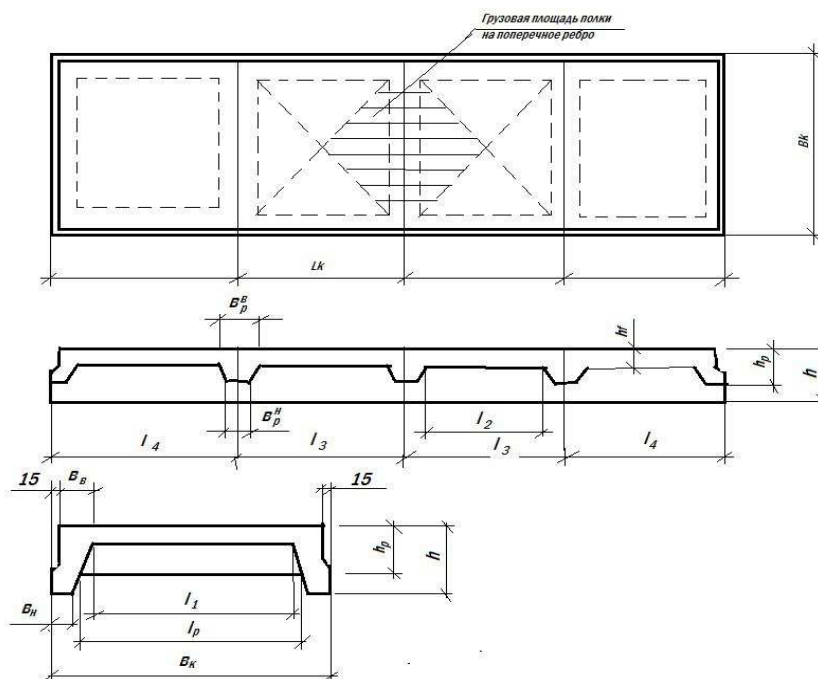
Опалубочный чертеж плиты 2ПГ6
